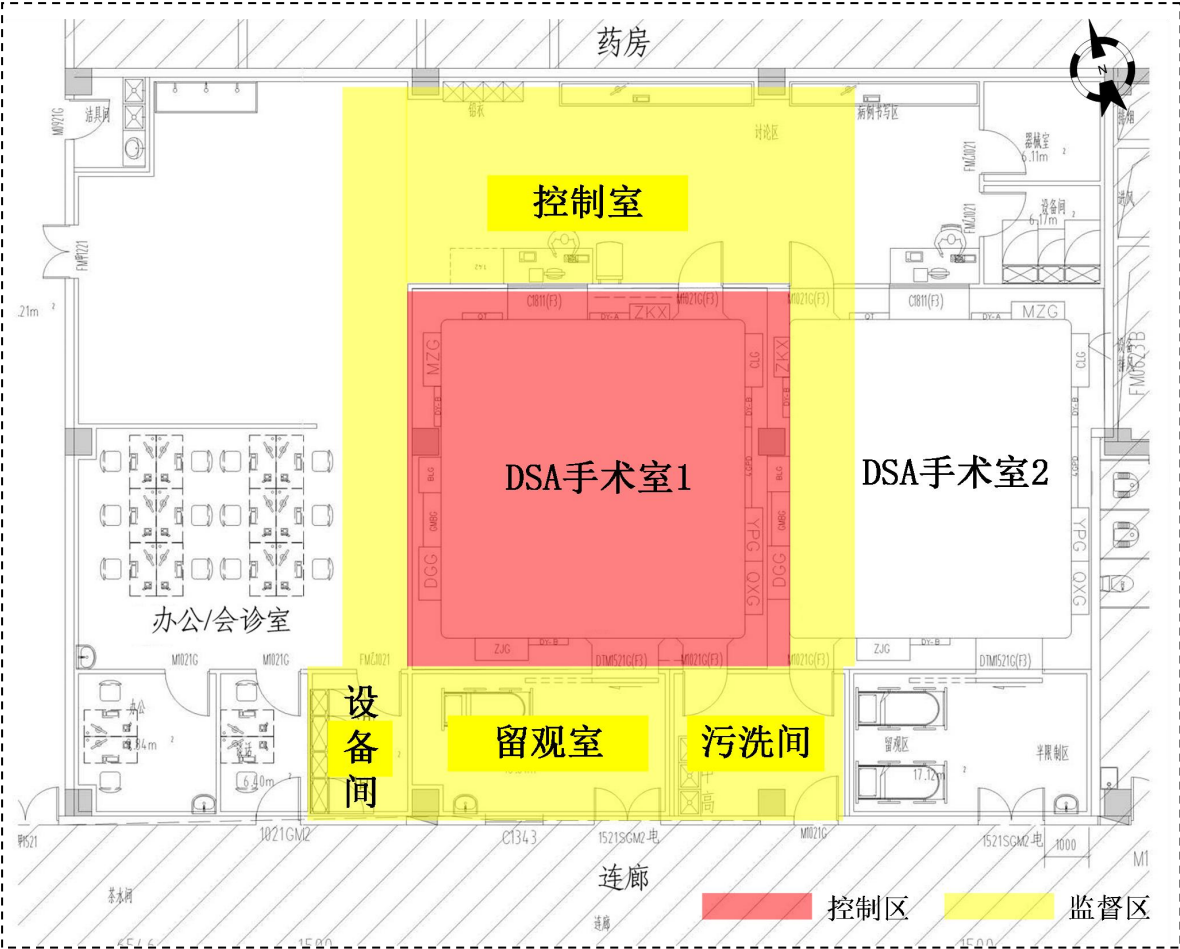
项目机房所在楼层平面布置图（医技楼 1 楼）
